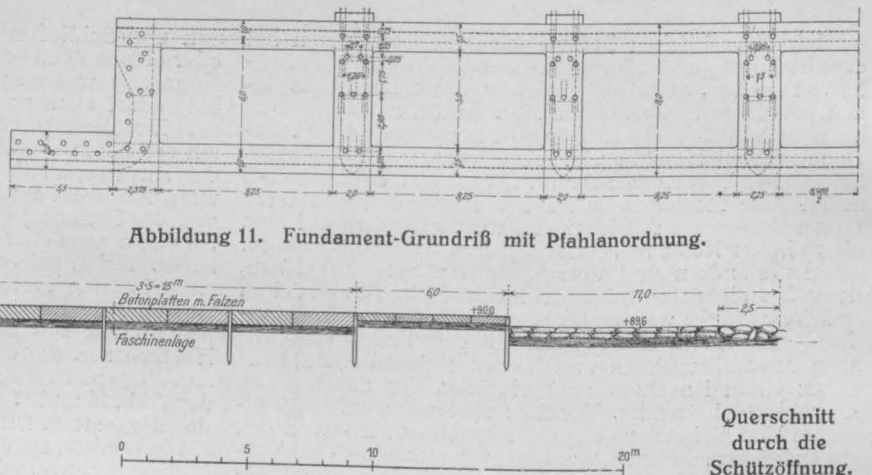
Fundament-Grundriß mit Pfahlanordnung.
